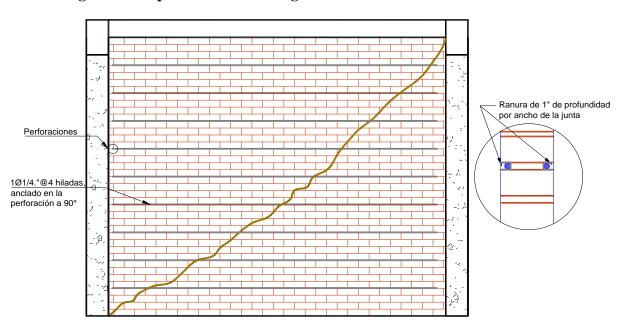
Reparación de muro agrietado con refuerzo horizontal.
